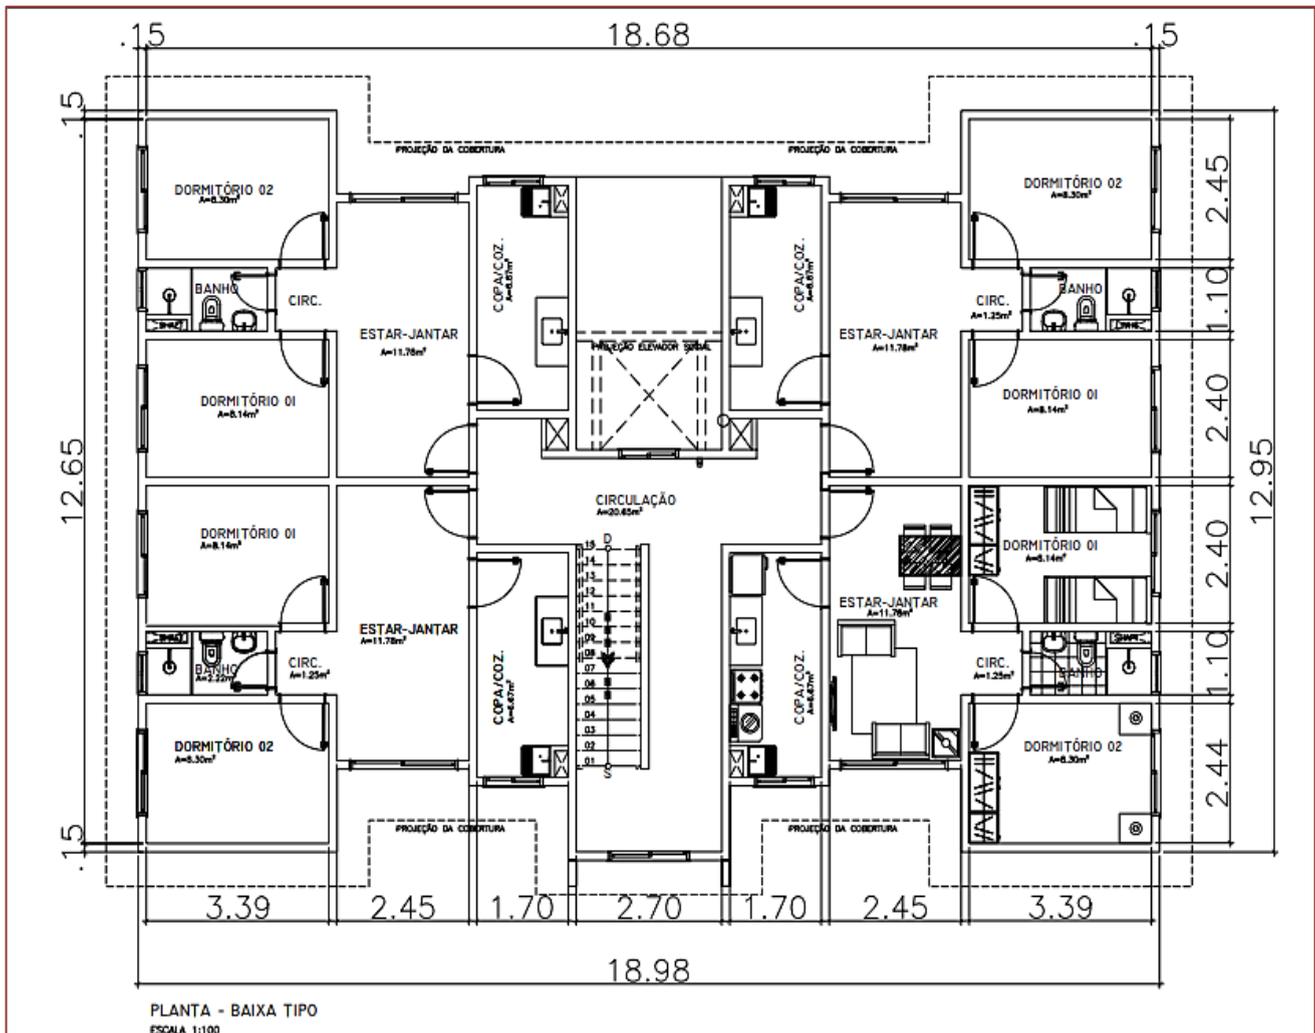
Planta baixa seguindo a norma coordenação modular para edificações.
